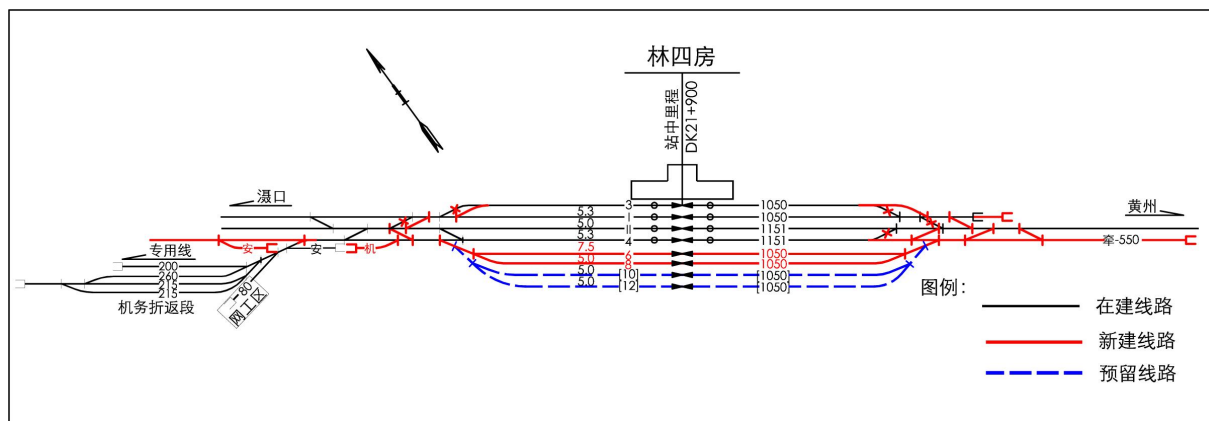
接轨站林四房站改扩建工程平面布置示意图
